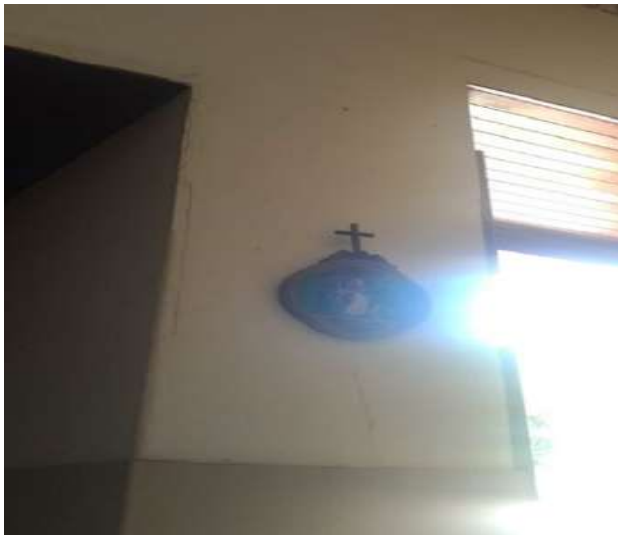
Parede entre as portas de entrada. Lado esquerdo. Patologia: fissura
